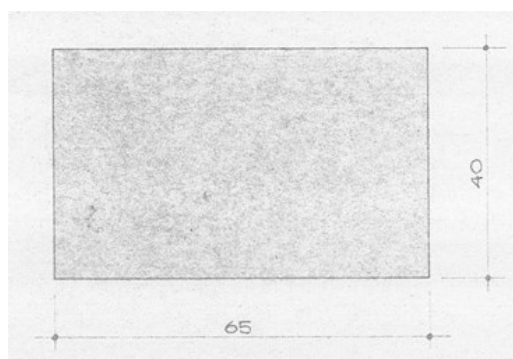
Vista in pianta dispositivo d'appoggio tipo
